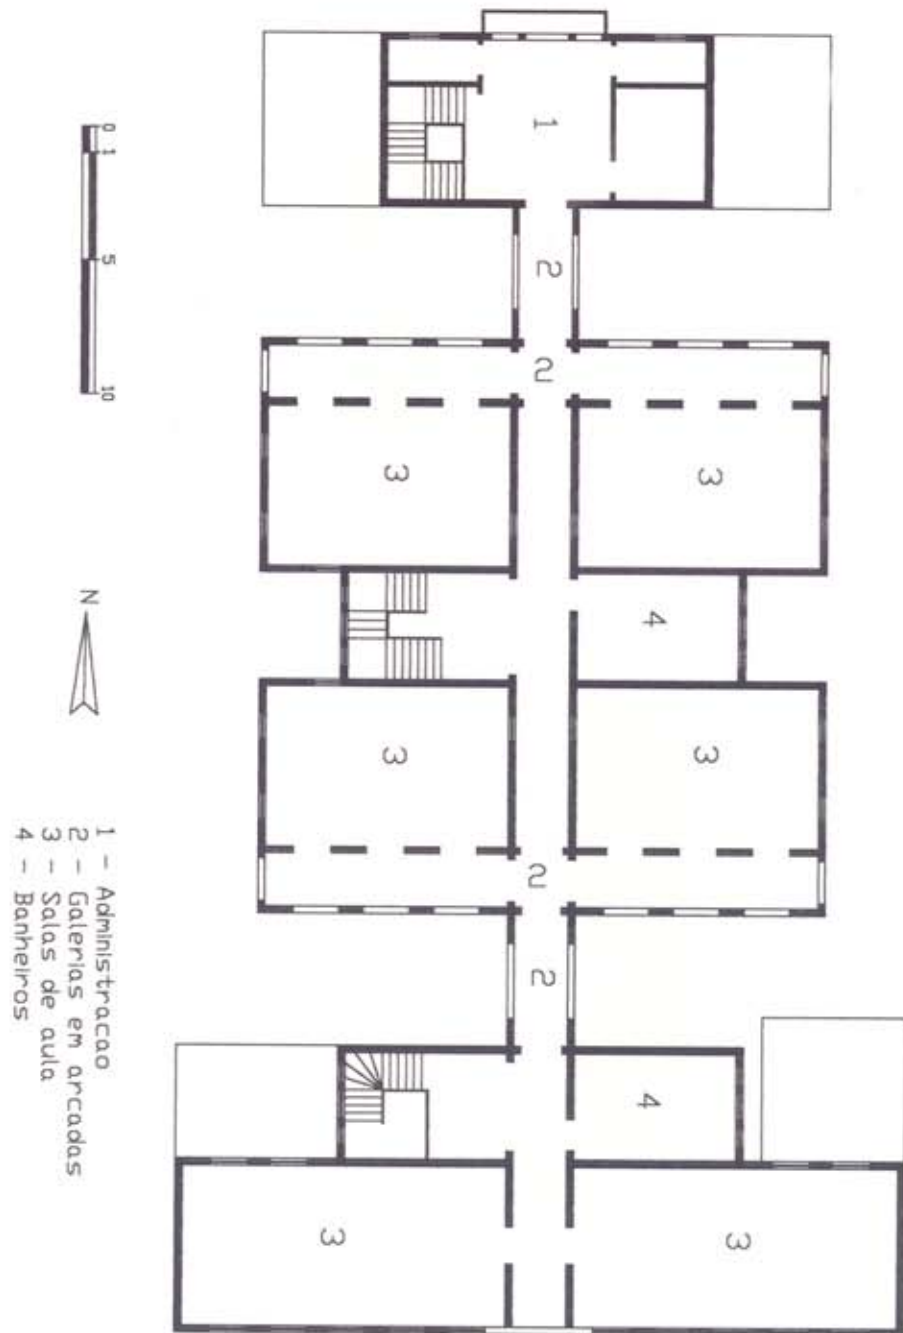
Planta baixa - disposiçao das salas de aula (2° e 3° pavimentos)
